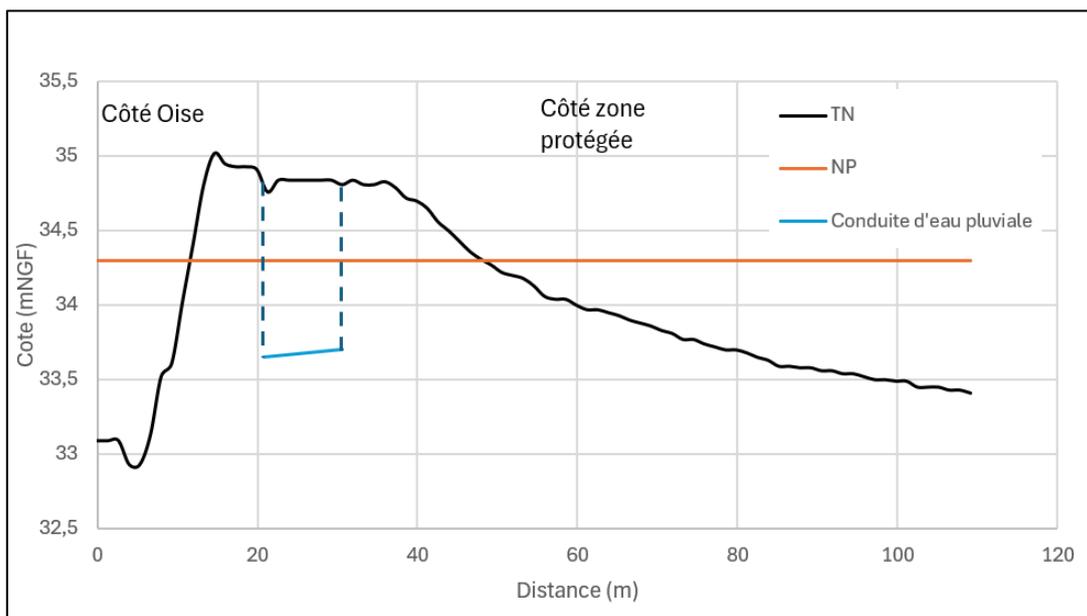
Profils en travers de la RD932 et l'emplacement de la canalisation traversante
